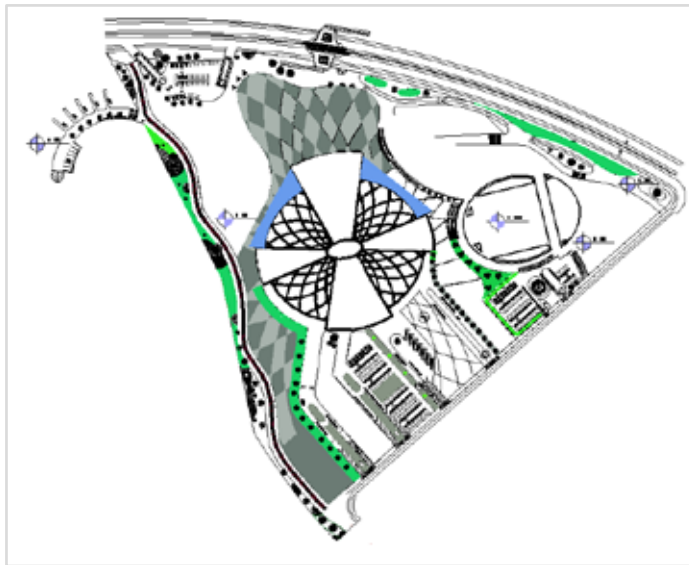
Planta Conjunto, Complejo de Natación. (2016)
